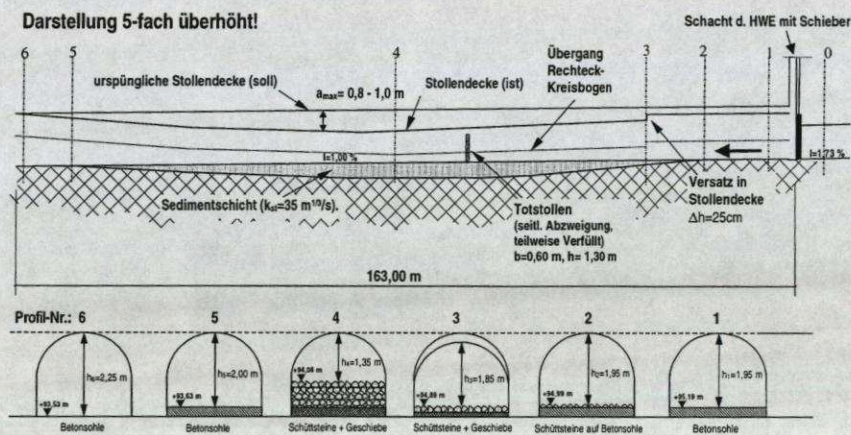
Längsschnitt des Grundablaßstollens "HRB Kasparstraße. Vergleich Plan zur tatsächlichen Situation
